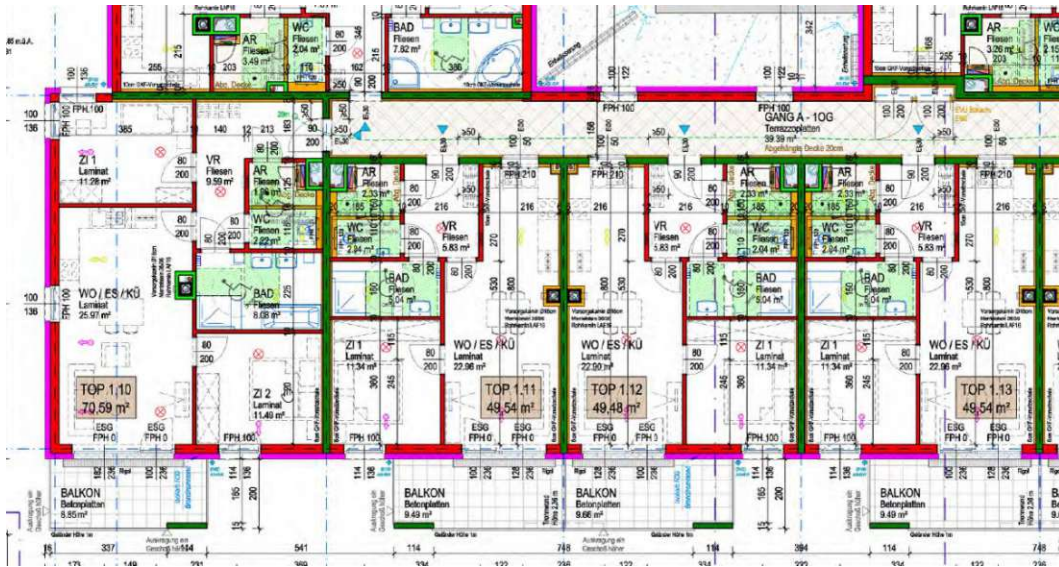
Auszug eines Regelgeschoßgrundrisses eines Mehrfamilienwohnbaus Baujahr 2019 (Auszug Bestandsplan Objekt 2492 Eggendorf „Neue Mitte“)
